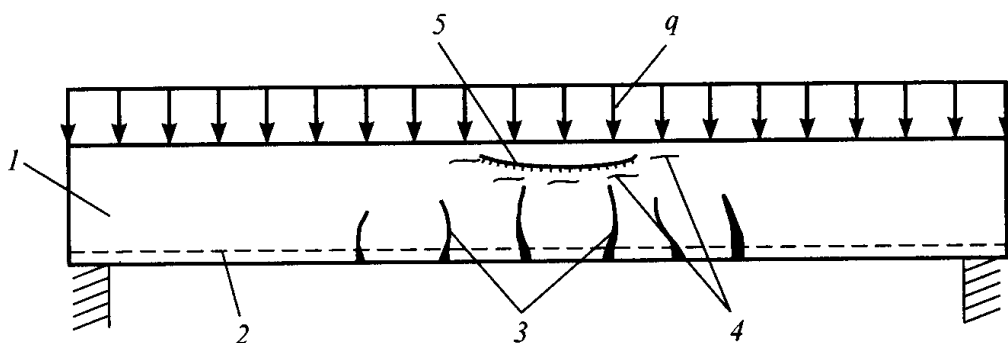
Оценка по раздроблению бетона сжатой зоны над наклонной трещиной:
